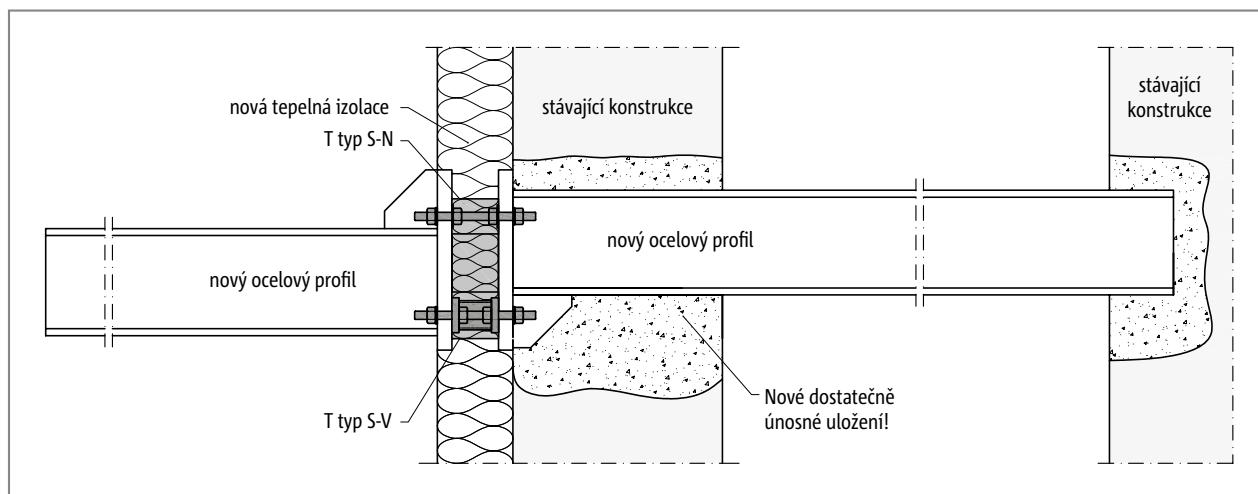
Schöck Isokorb® T typ S-N a T typ S-V: Dodatečně provedený volně vyložený ocelový balkón; napojení na dodatečně zabudovaný ocelový nosník
